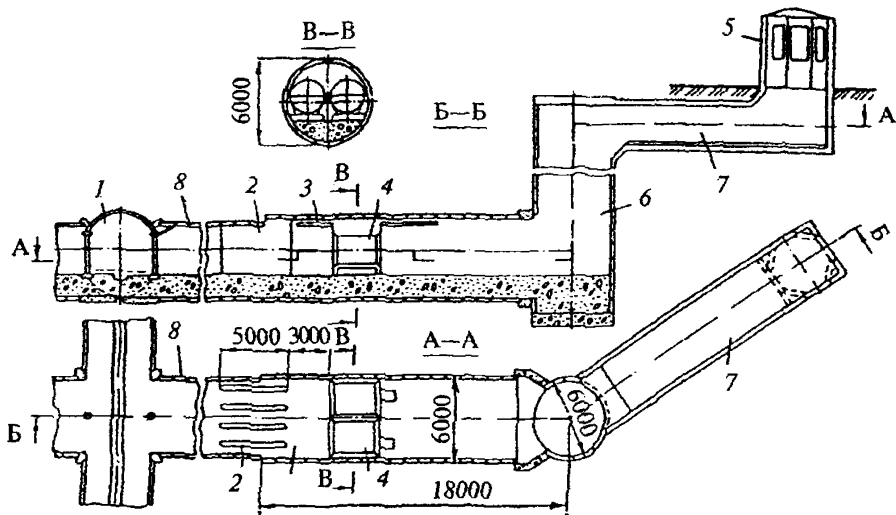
Вентиляционные сооружения на перегоне глубокозаложенной линии
